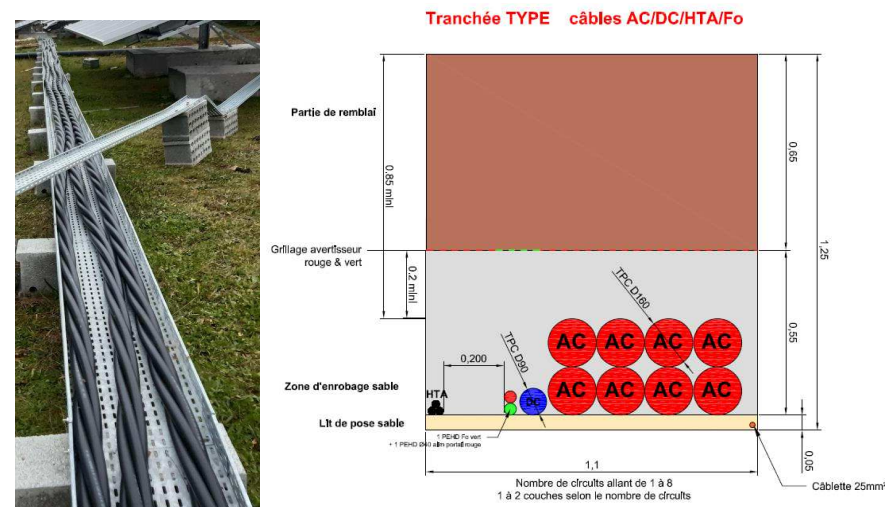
Exemples d'un chemin de câble et d'un plan d'une tranchée (Source : SOLARVIA)
